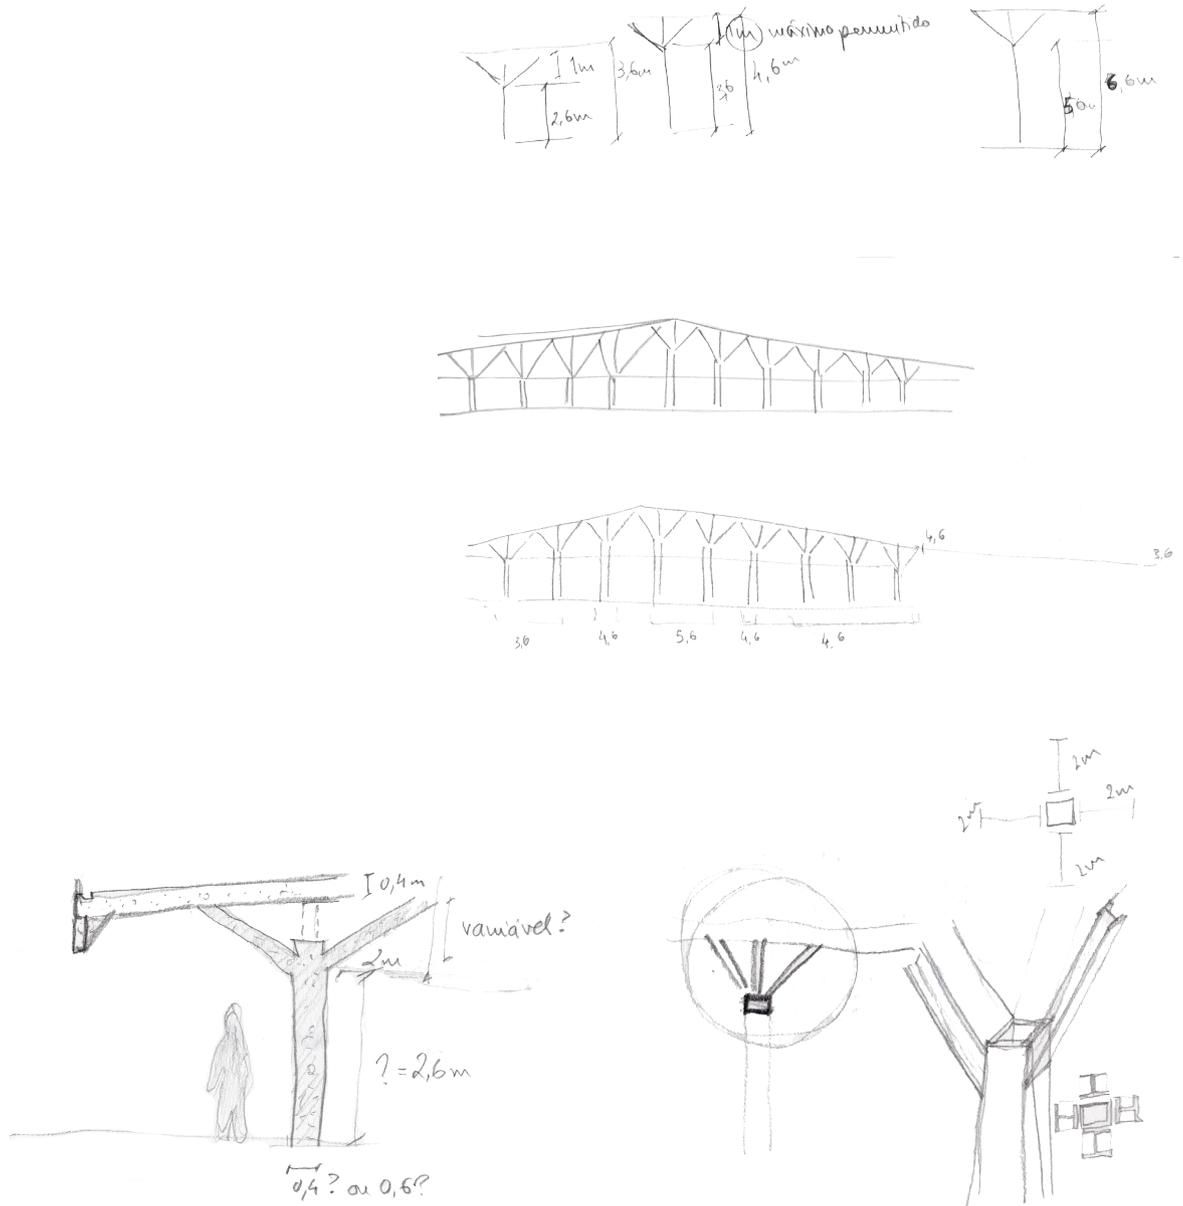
Estudos da relação da estrutura com a cobertura e as fachadas exteriores
